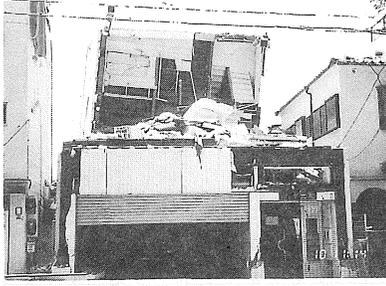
高層住宅の柱の脆性破壊と接合部の脆性破壊
